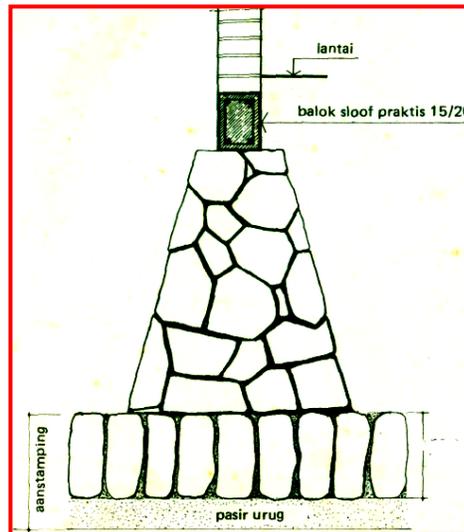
, Batu Kali Sebagai Bahan Konstruksi Pondasi Batu Belah
